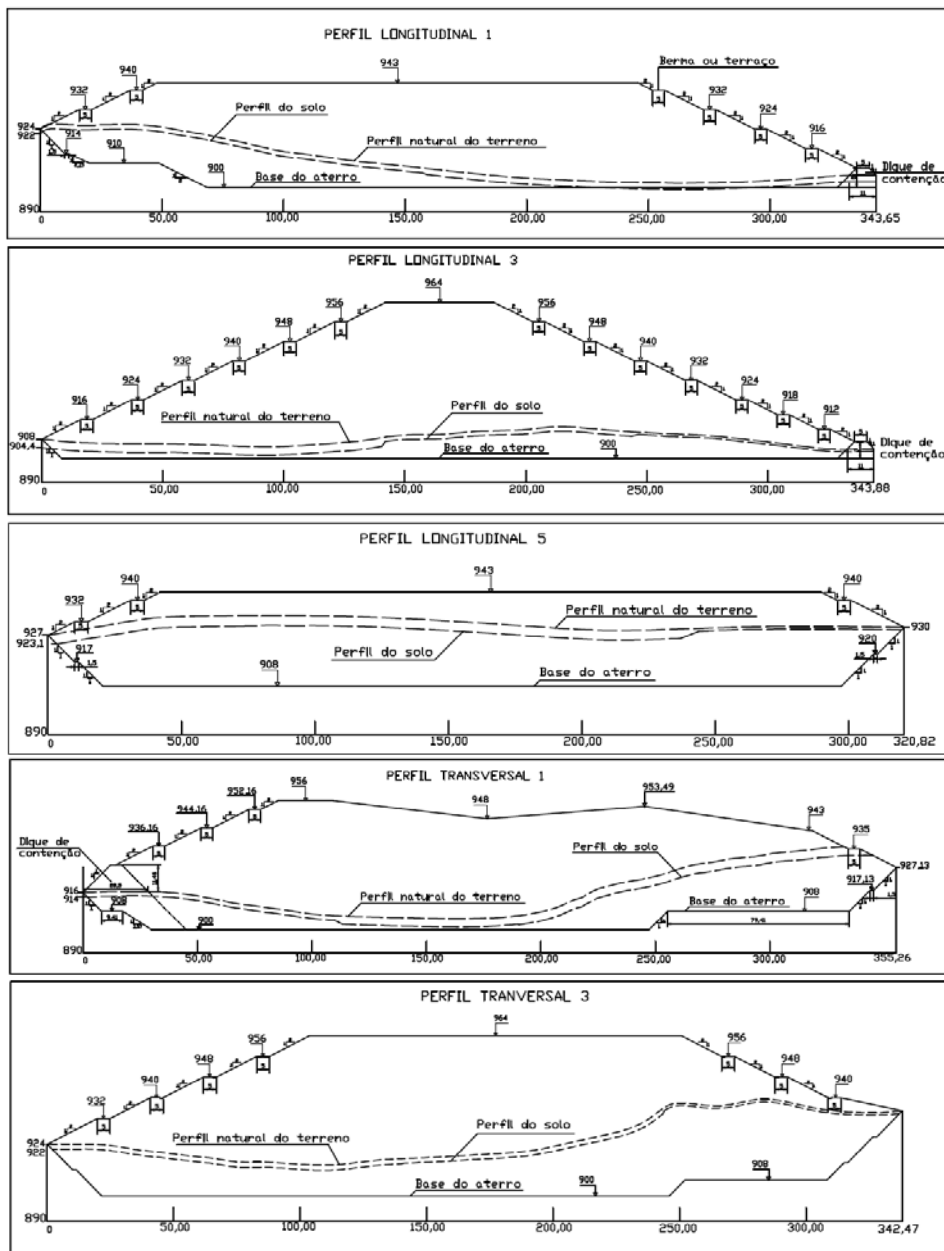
Perfis longitudinais e transversais do aterro sanitário. Fonte: Moratelli (2009).
